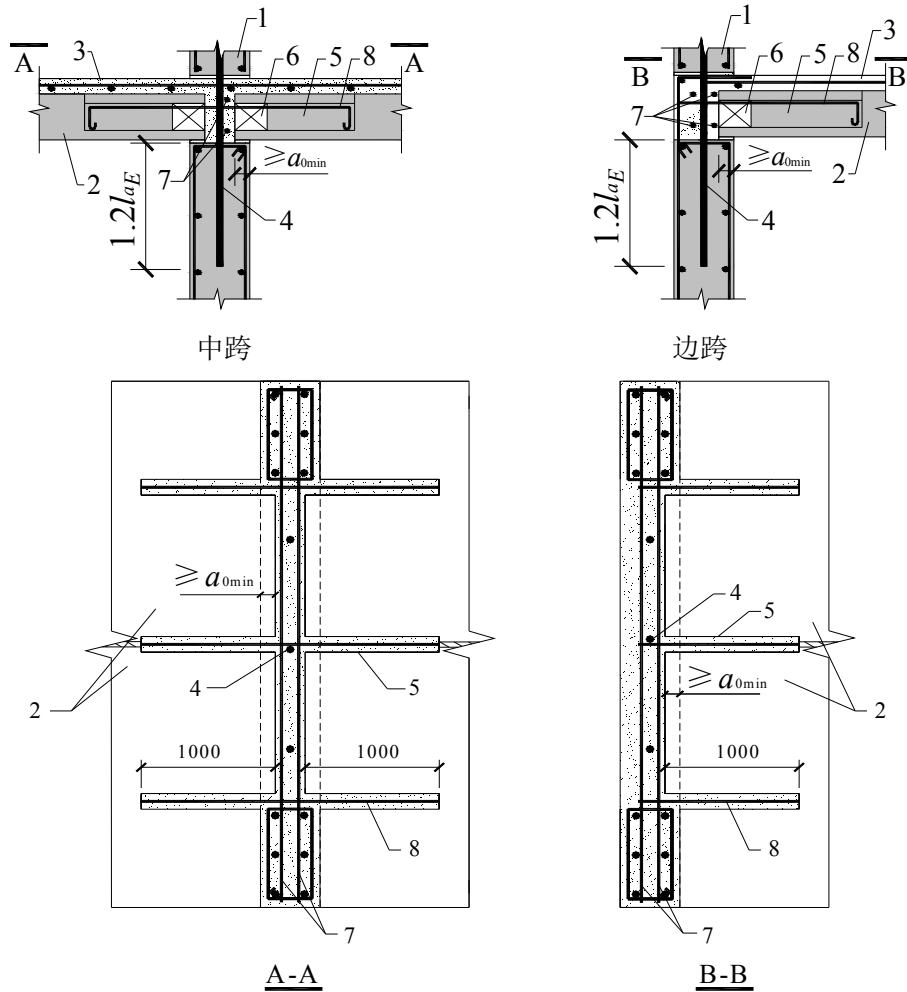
预应力空心叠合楼板装配整体式剪力墙构造示意
